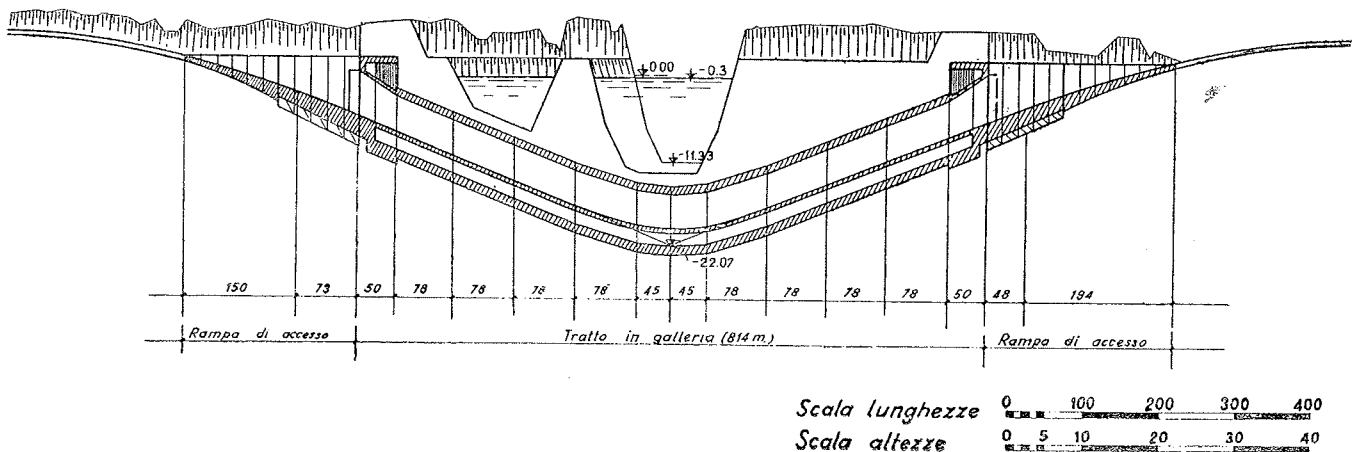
Soluzione di progetto - Profilo longitudinale
